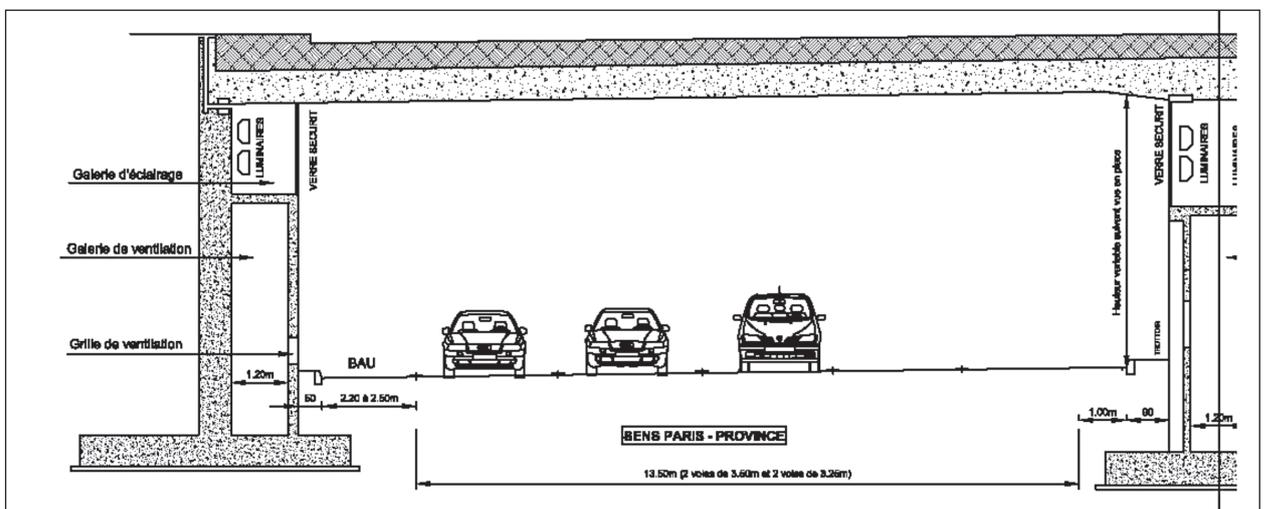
Coupe d'une demi-chaussée de la tranchée couverte de Champigny sur l'autoroute A4
